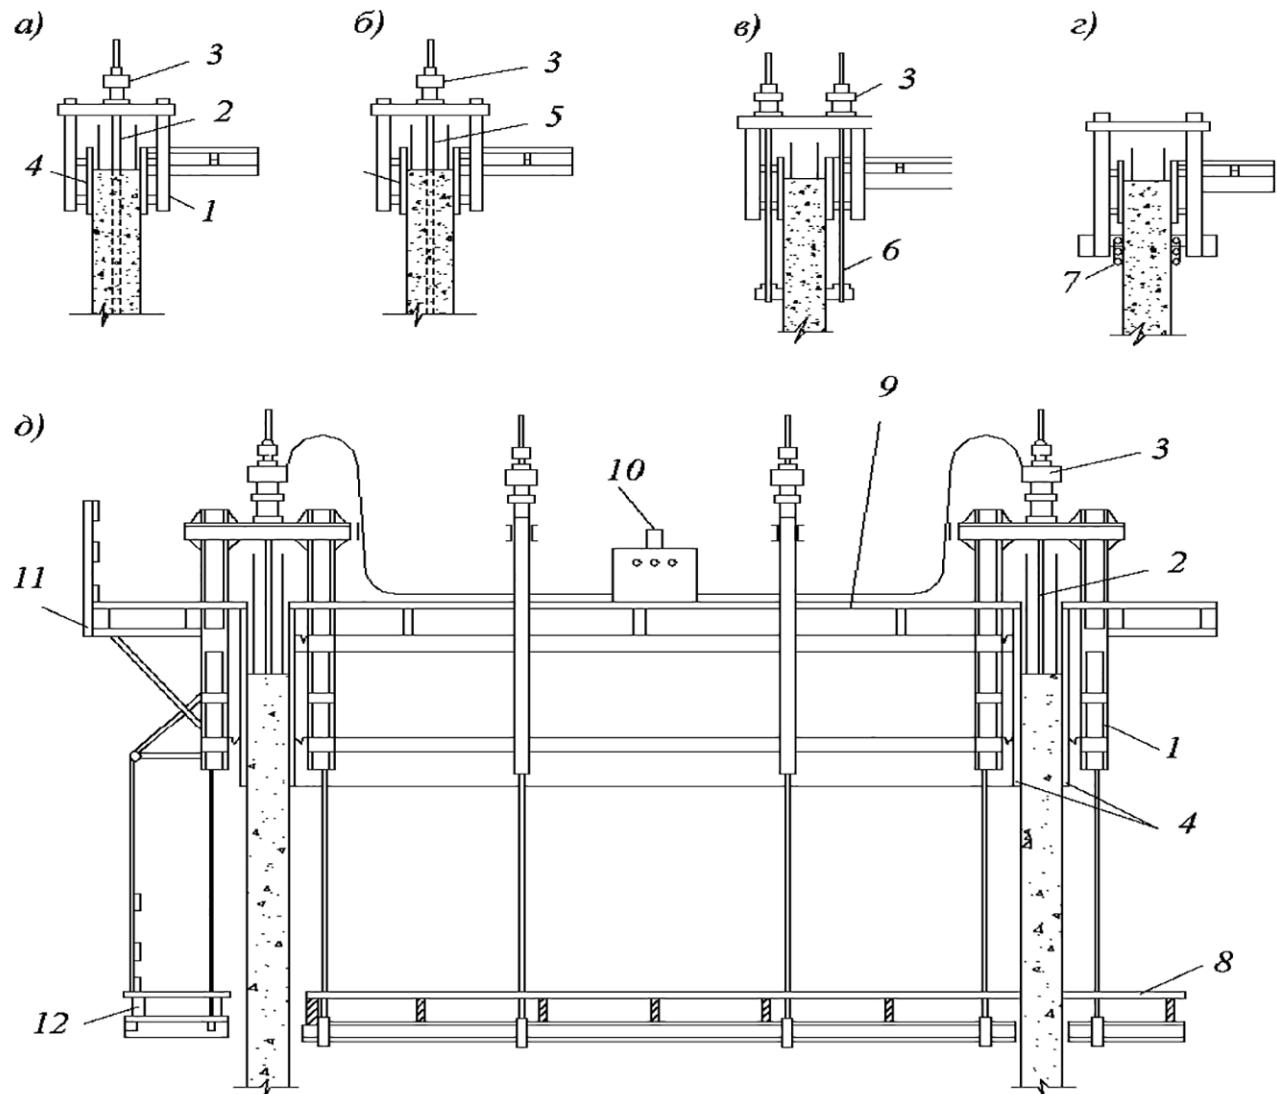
Скользящая опалубка: *а* – с несъемными домкратными стержнями; *б* – со съемными домкратными стержнями; *в* – с домкратными стержнями вне конструкции; *г* – со специальным механизмом подъема; *д* – общий вид опалубки; 1 – домкратная рама; 2 – домкратный стержень несъемный; 3 – домкрат; 4 – щит опалубки; 5 – домкратный стержень съемный; 6 – домкратный стержень вне конструкции; 7 – специальный механизм подъема; 8, 12 – внутренние и наружные навесные подмости; 9 – рабочий настил; 10 – насосная станция; 11 – защитный козырек
